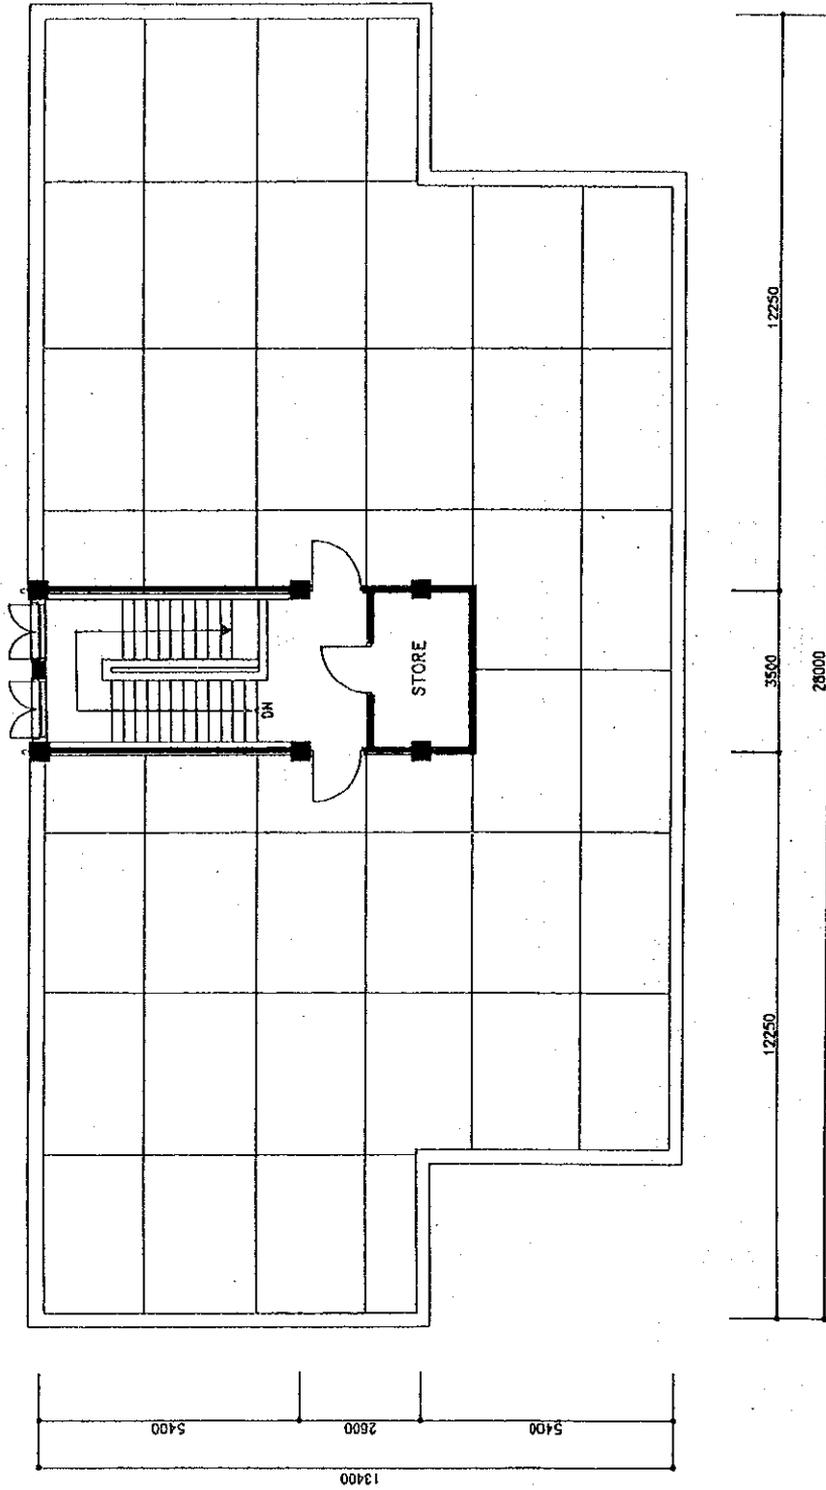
(3) 屋階平面図 (5 教室タイプ)
